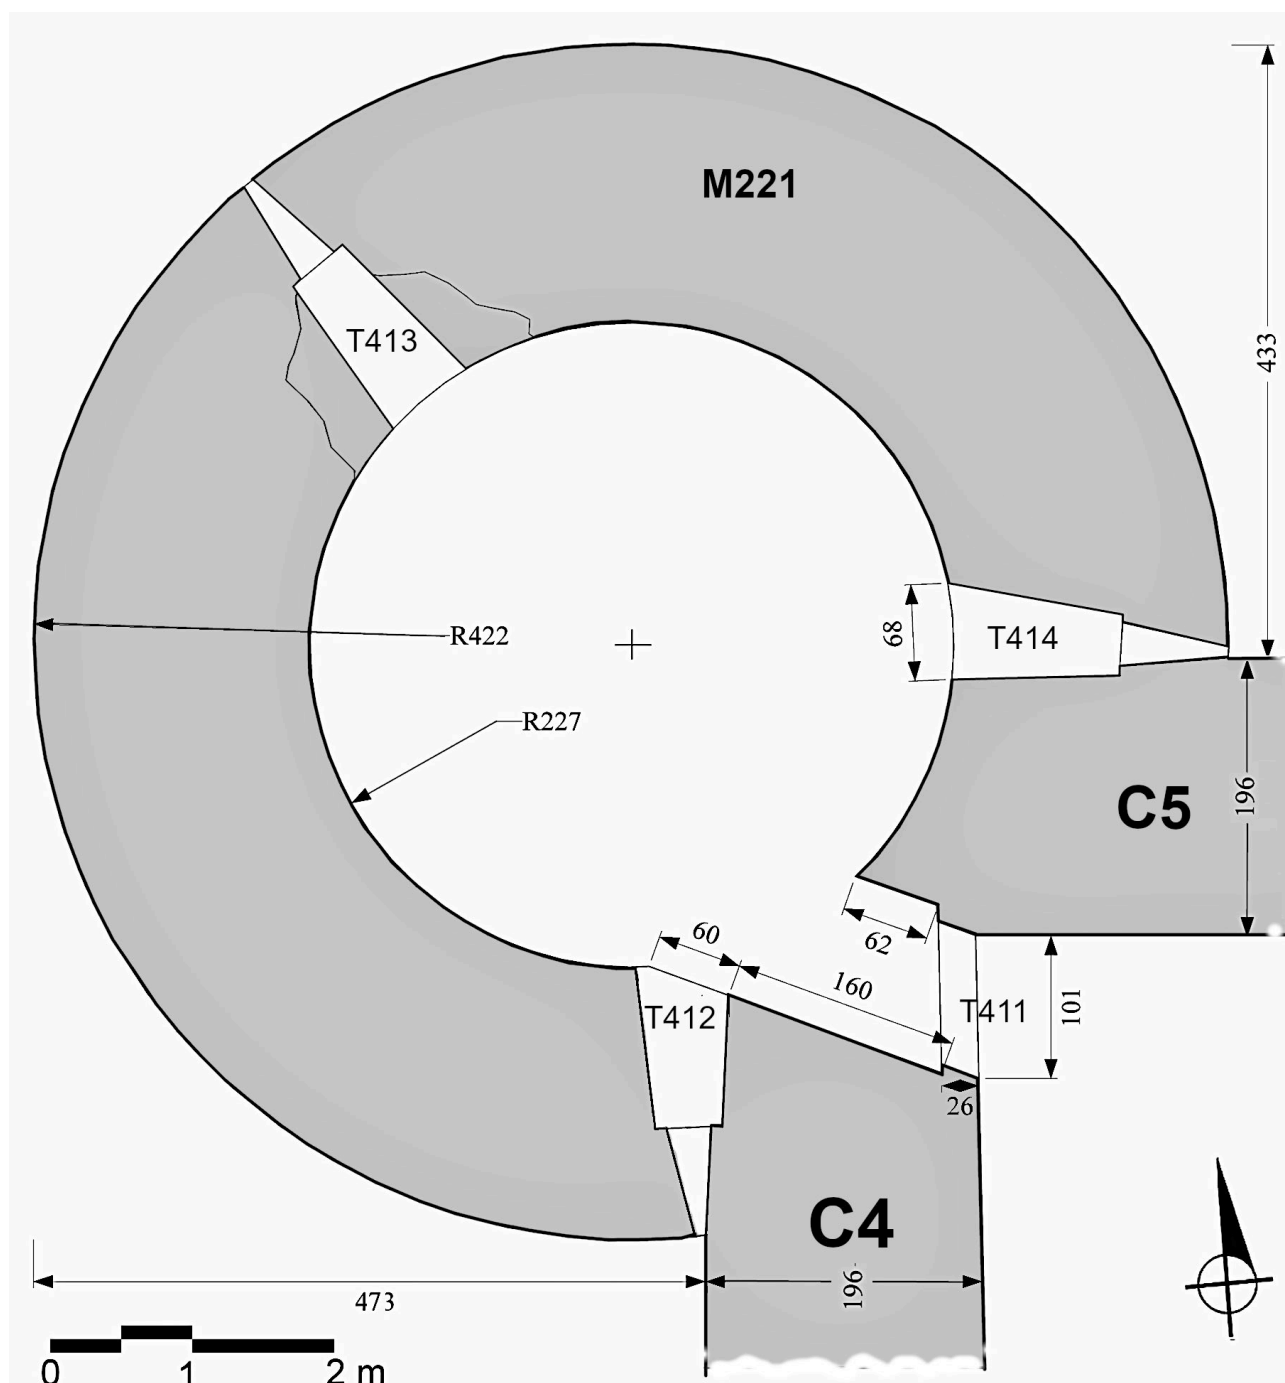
Tour nord-ouest (T4), plan du niveau 1 (DAO : Michel Piechaczyk, ADM).
